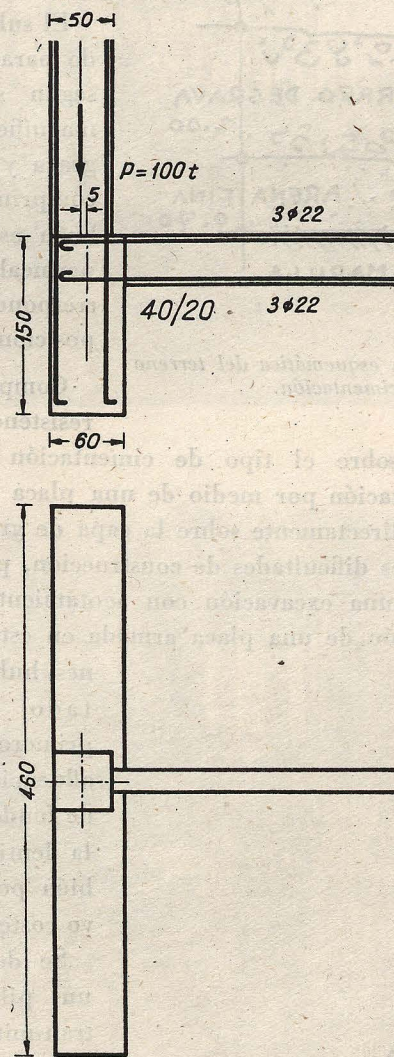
Zapata de cimentación de un pilar con viga centradora. (Comparar con los valores de figuras 3 y 5.)
